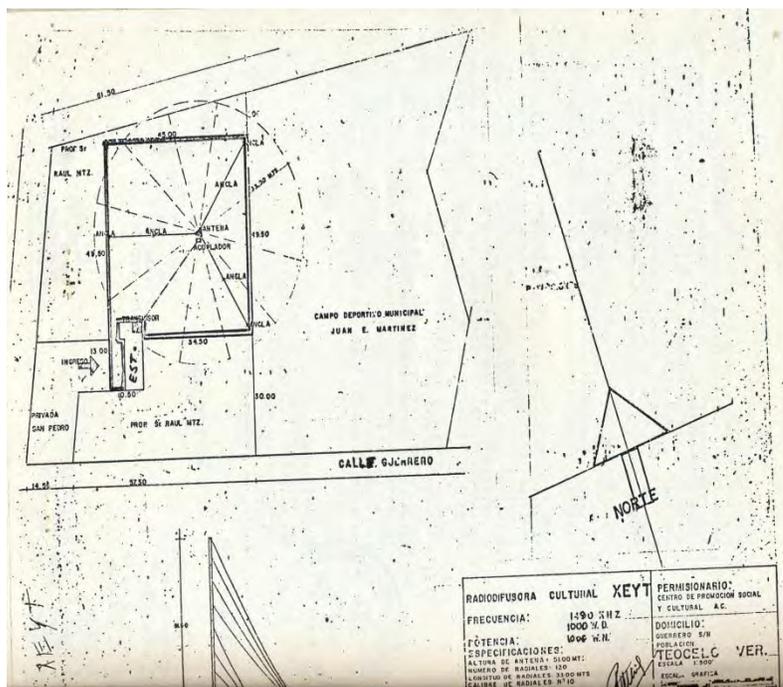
Planos para la nueva planta transmisora e instalaciones. Archivos de la XEYT: 1983
